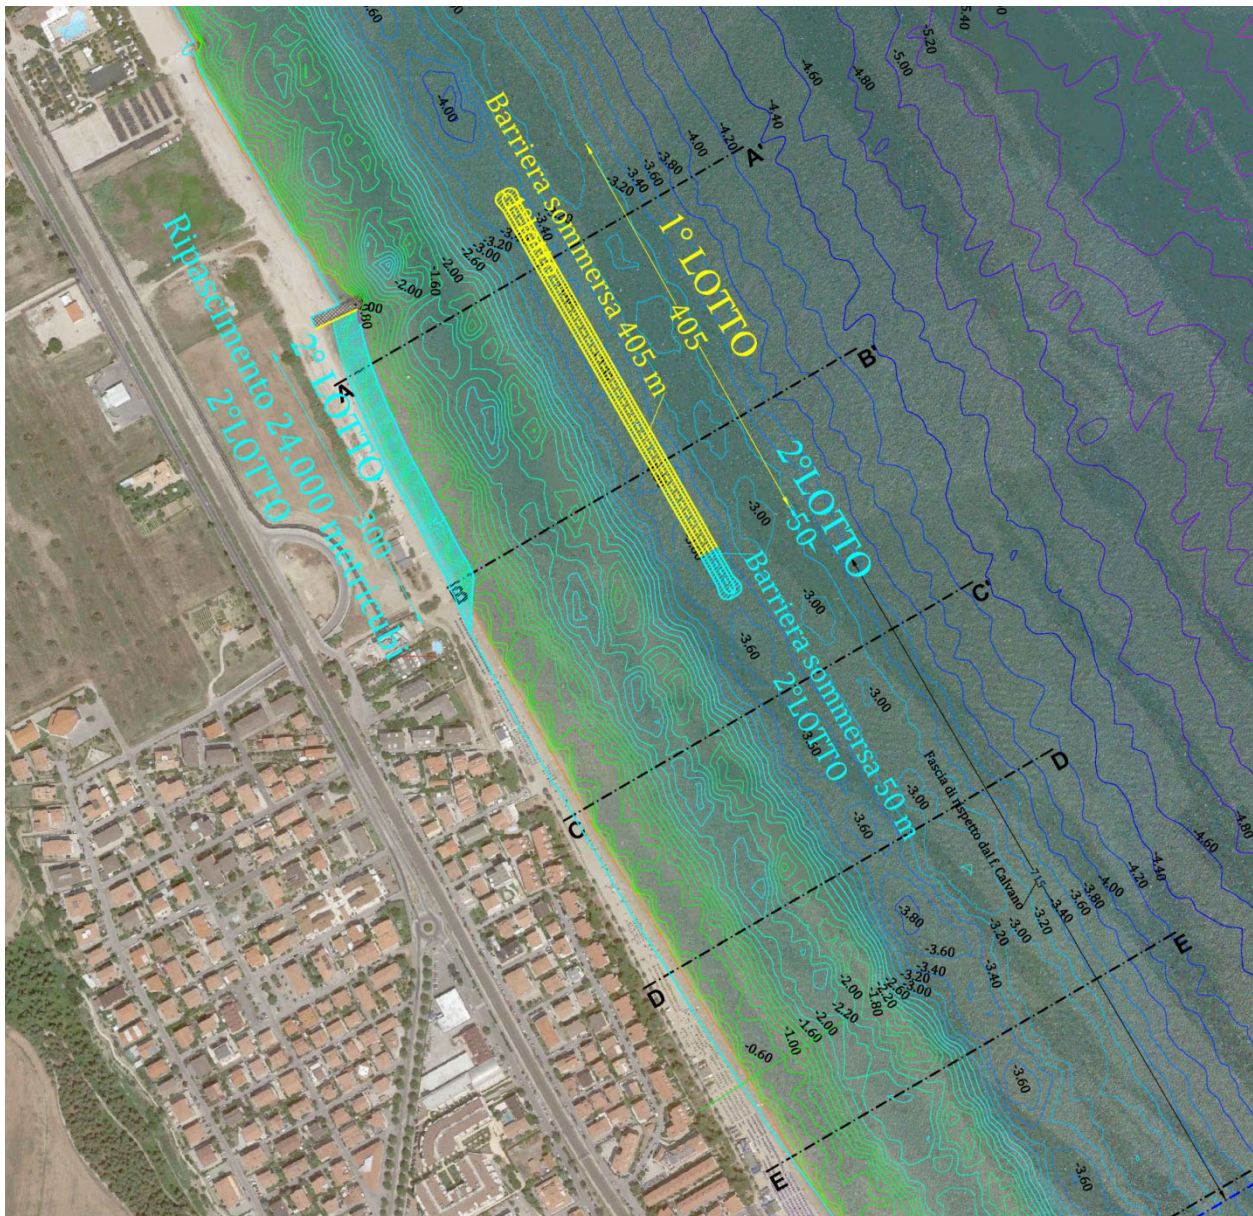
Interventi di 1° e 2° Lotto da progetto
